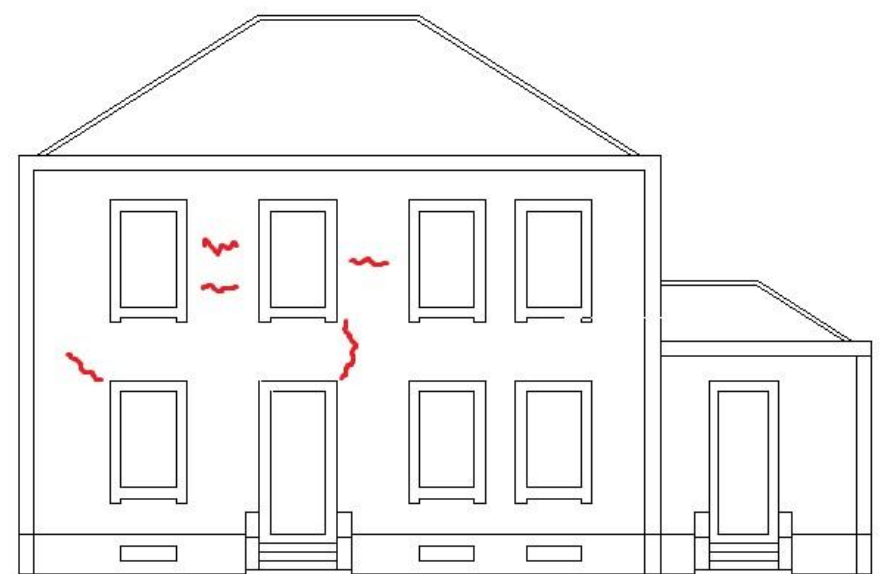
Fissuração na fachada lateral direita
